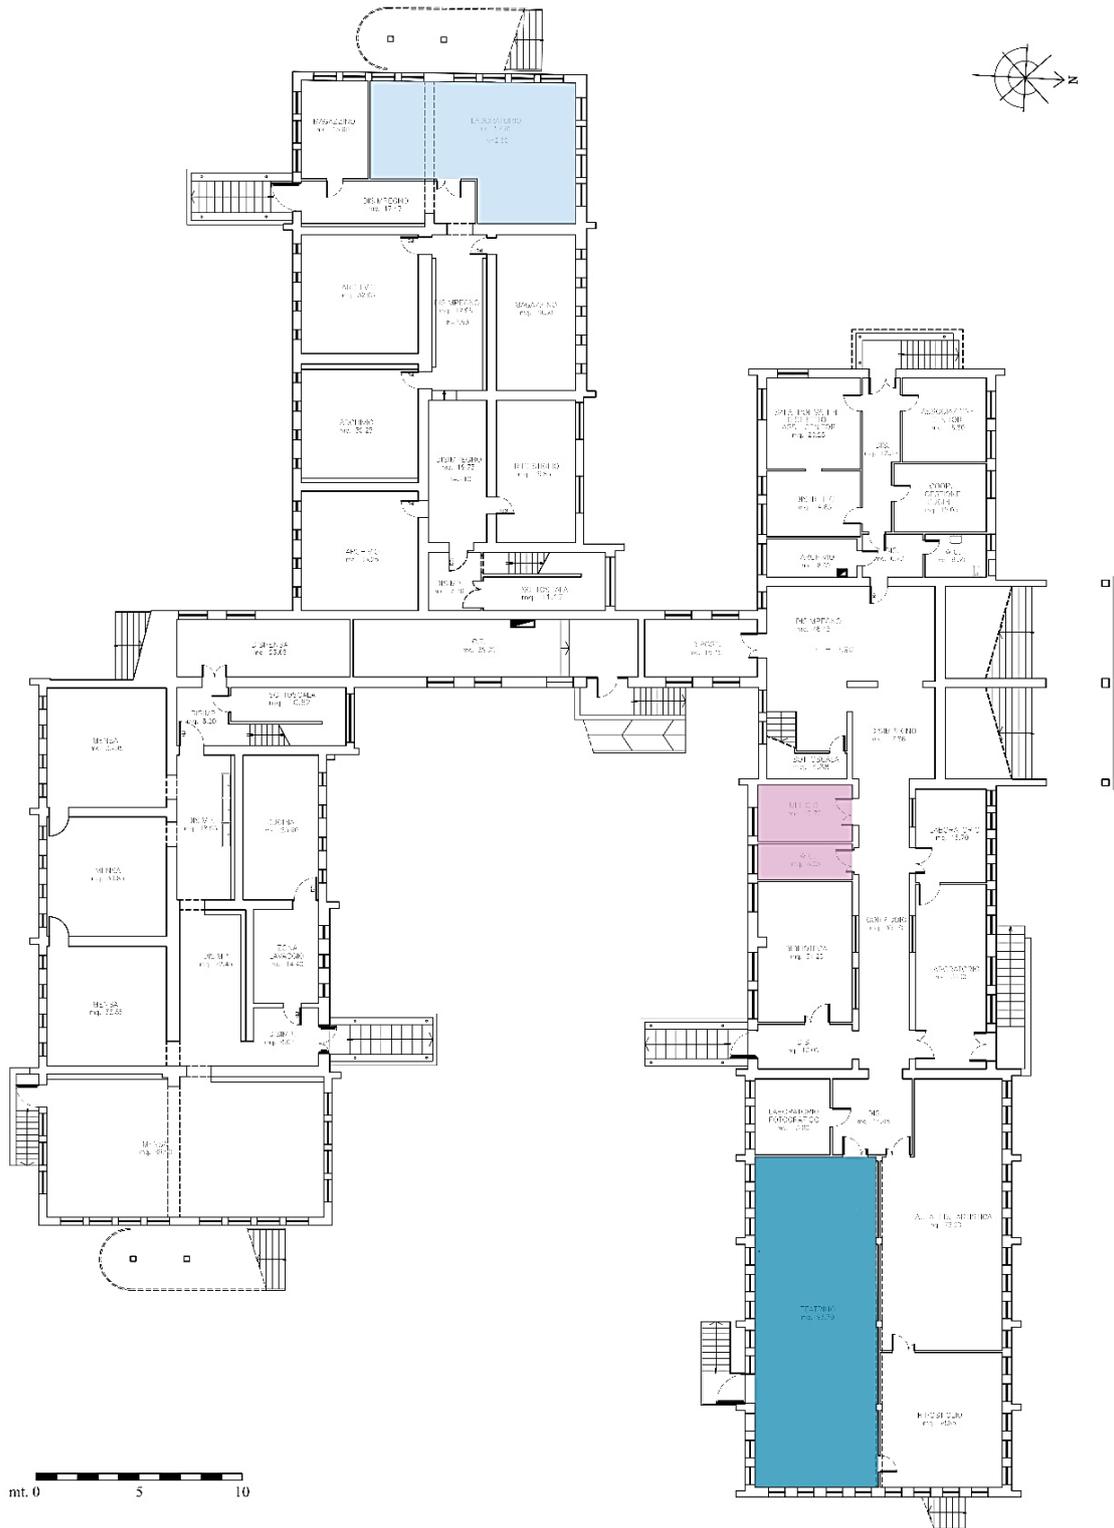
Pianta piano seminterrato, esigenze didattiche
